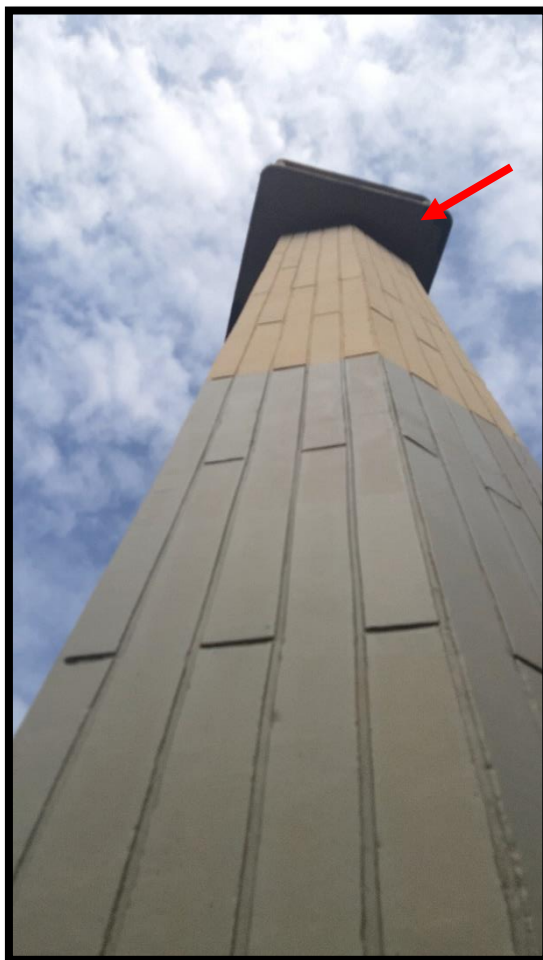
Torre do Relógio (Armadura Exposta na laje )
